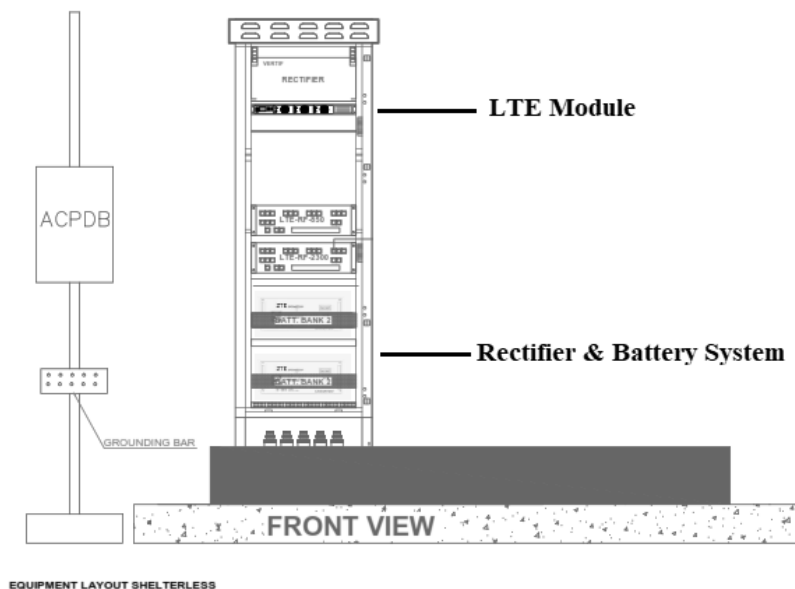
Layout existing shelter dan BTS Outdoor
